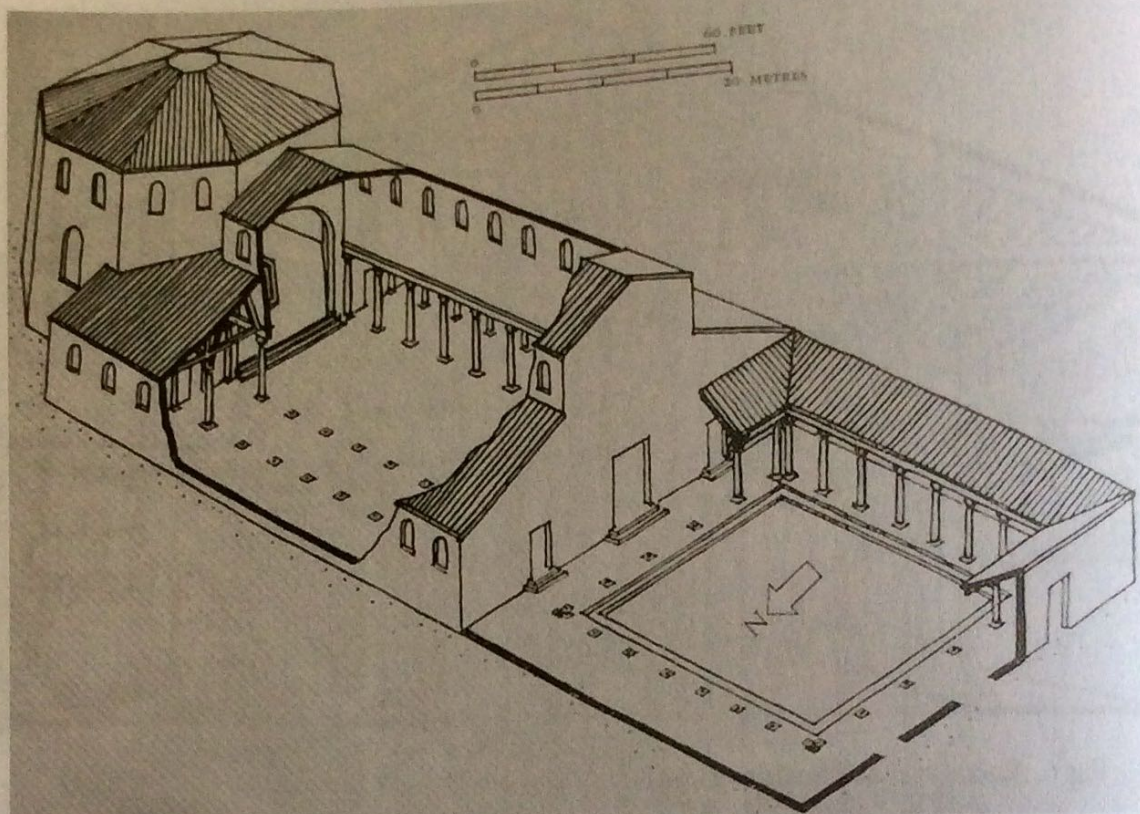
Planta da Basílica da Natividade em Belém, segundo Krautheimer (1965 e 2009)
